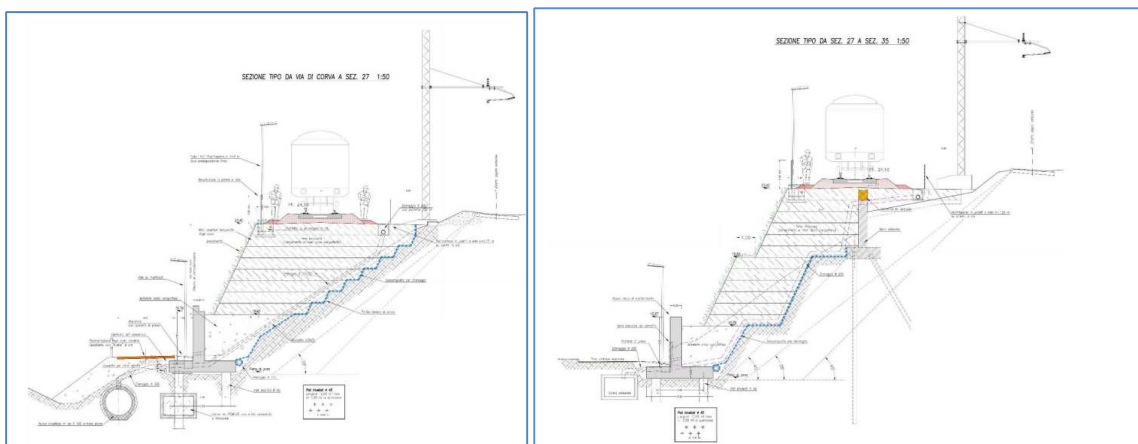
Confronto della sezione tipo del nuovo rilevato ferroviario: a sinistra senza modifica, a destra con modifica
